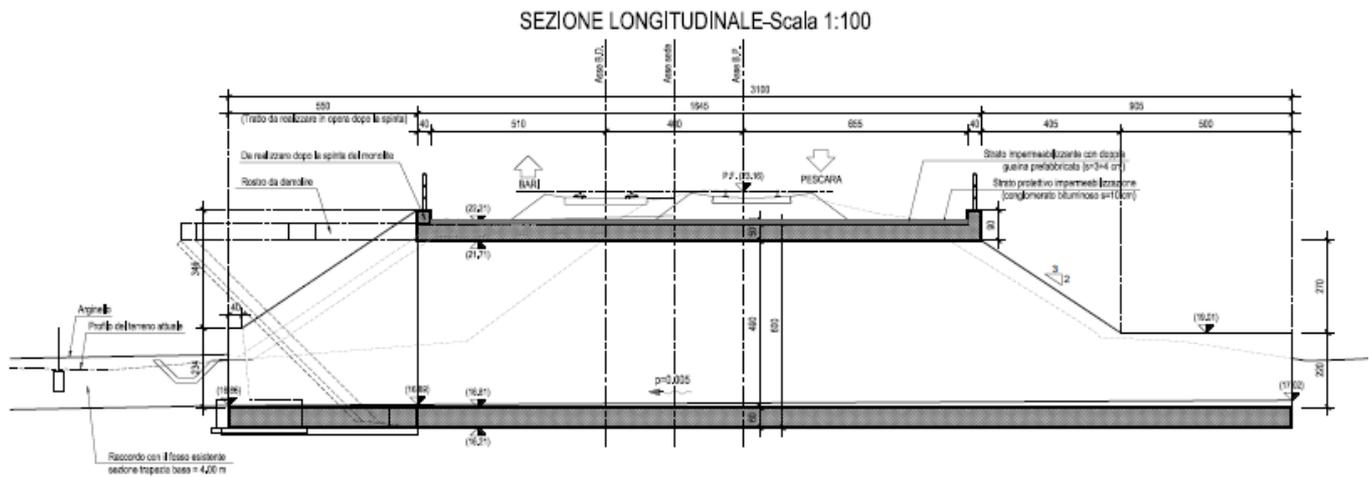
Scatolare km 5+755 - Sezione Longitudinale
